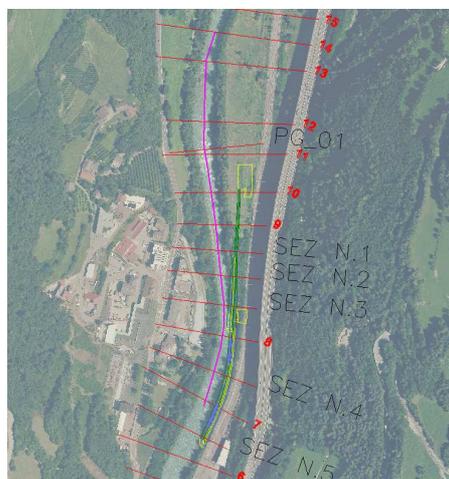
Planimetria di localizzazione delle sezioni trasversali.
